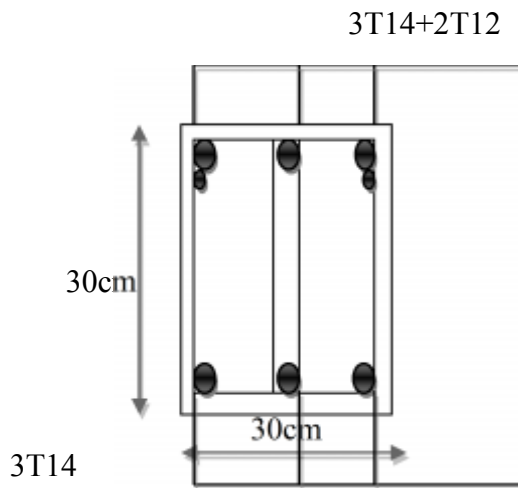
Ferrailage de la poutre secondaire en appuis
